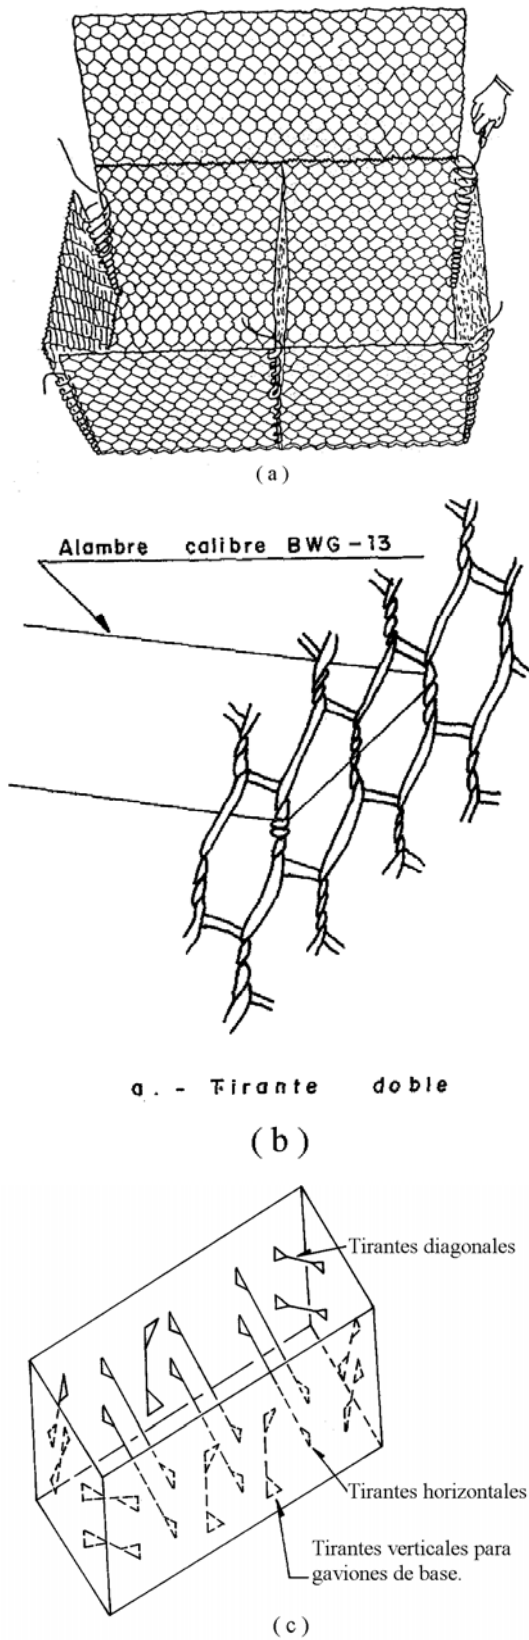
Detalles constructivos de muros de gaviones (Suárez, 1992).
